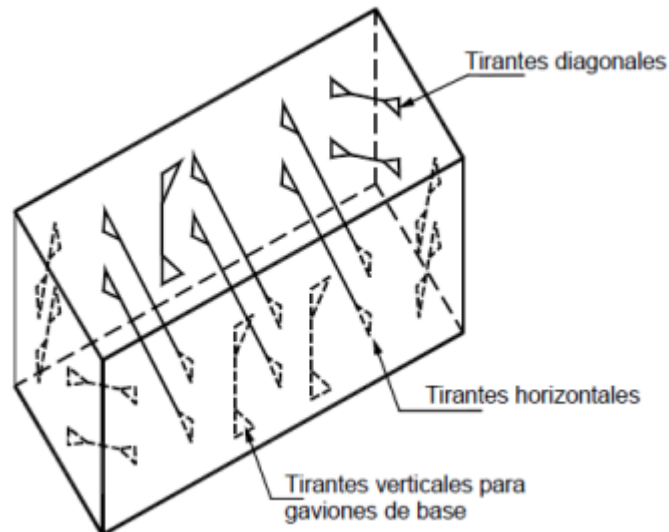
Esquema de Colocación de Tirantes en Gavión.
